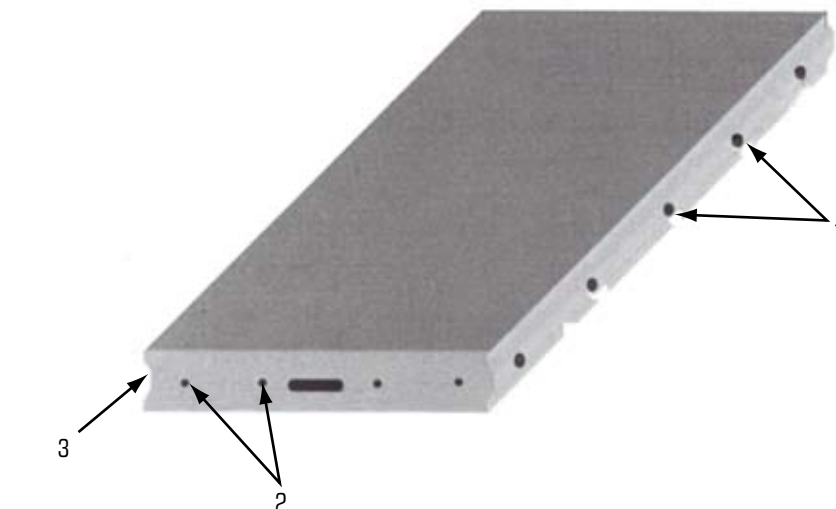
Современная дорожная плита из преднапряженного бетона (США): 1 — продольные сквозные каналы; 2 — поперечная преднапряженная арматура; 3 — спунтованные боковые грани (торцы) плит
